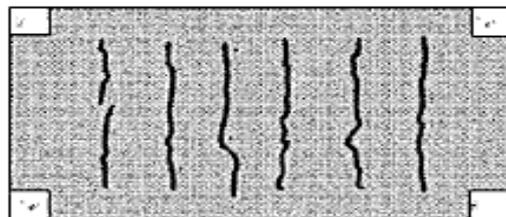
FISURAS DE CONTRACCIÓN HIDRÁULICA Y TÉRMICA
